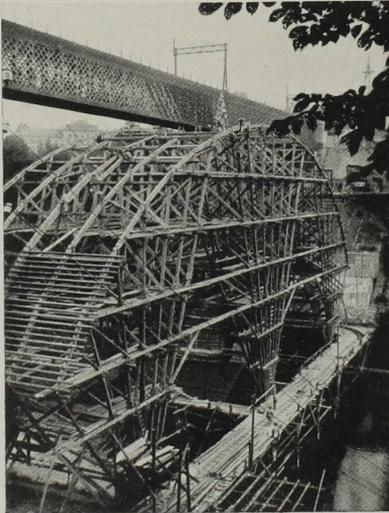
Lehrgerüst der Lorrainebrücke in Bern
